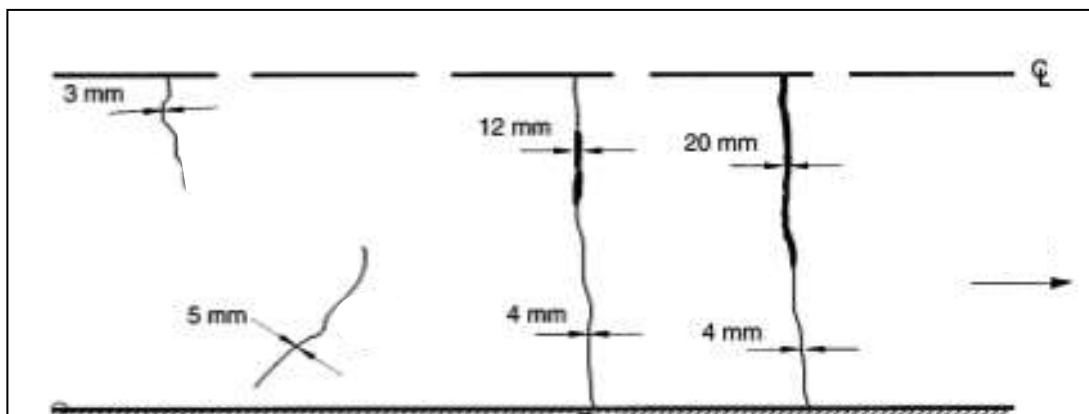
Grietas Transversales. (FHWA, 2003)
